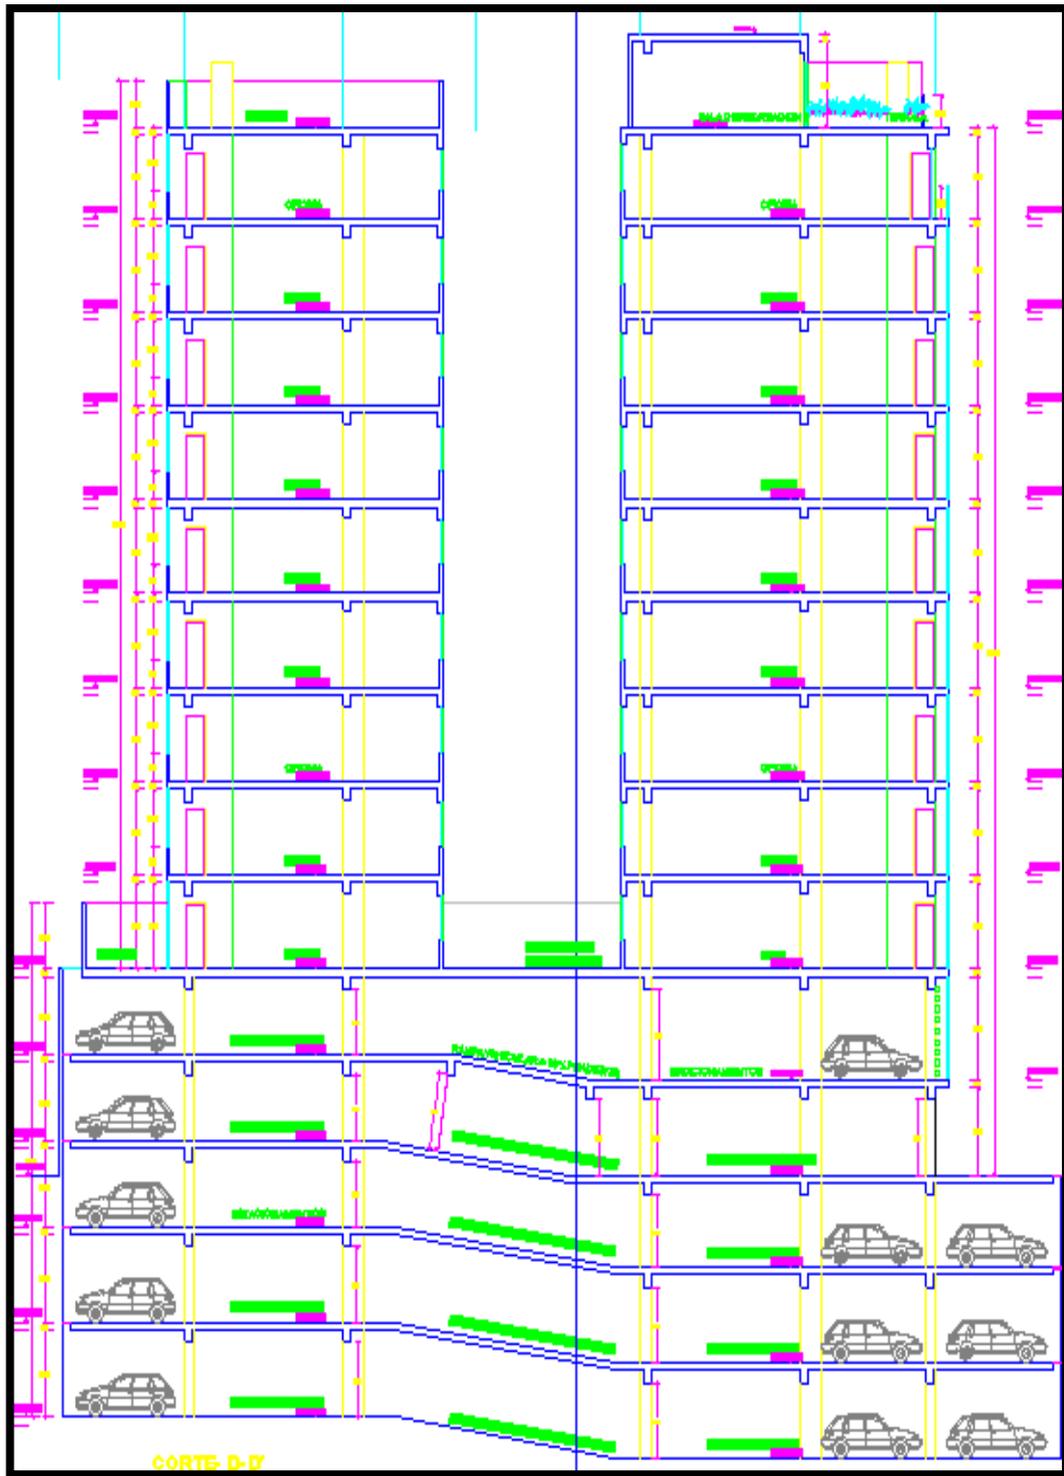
Plano de Corte D-D'- Longitudinal Edificio Monte Rosa
